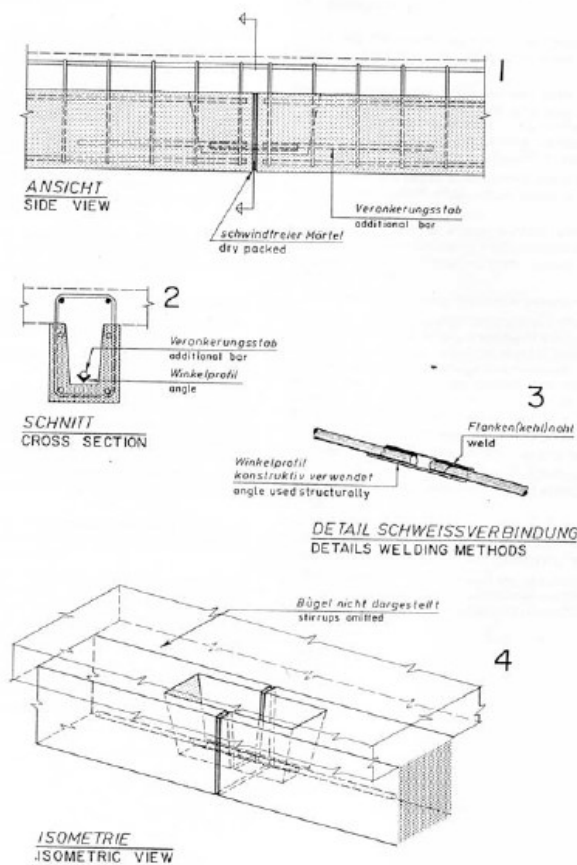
Ligação por juntas em dente e barras de aço inferiores soldadas (Stupré, 1981)
